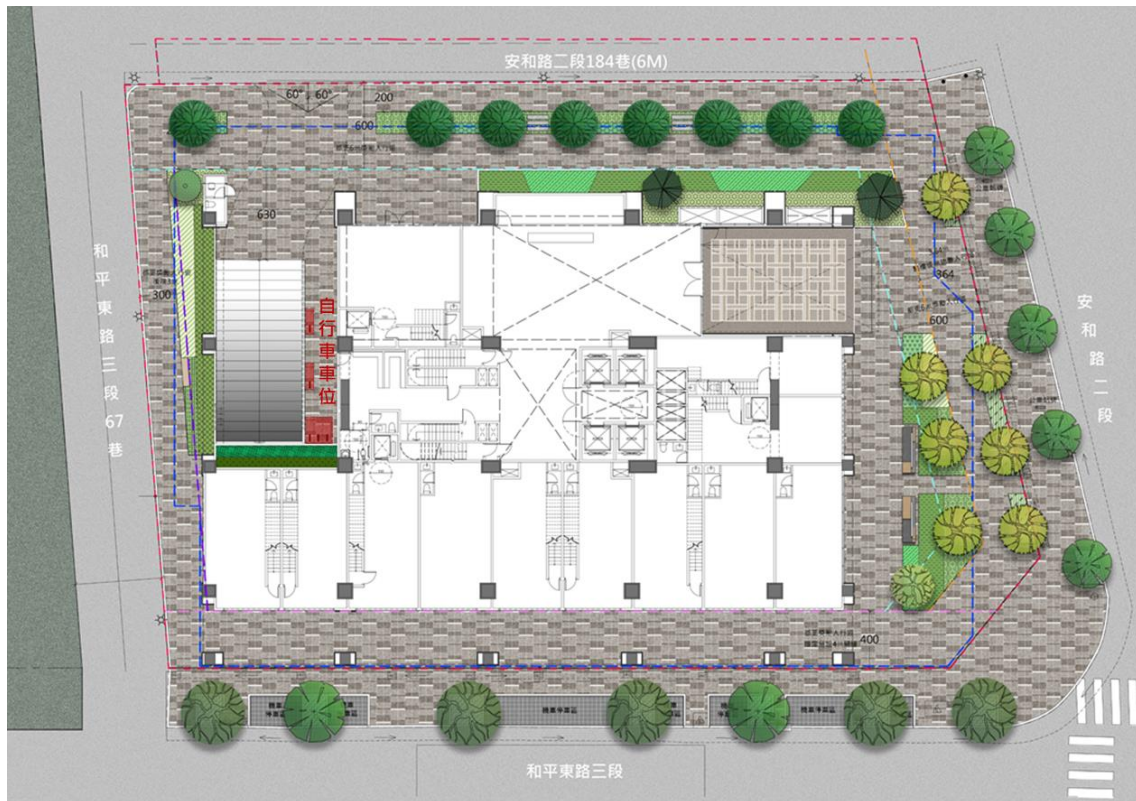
地面層平面及景觀植栽配置示意圖
